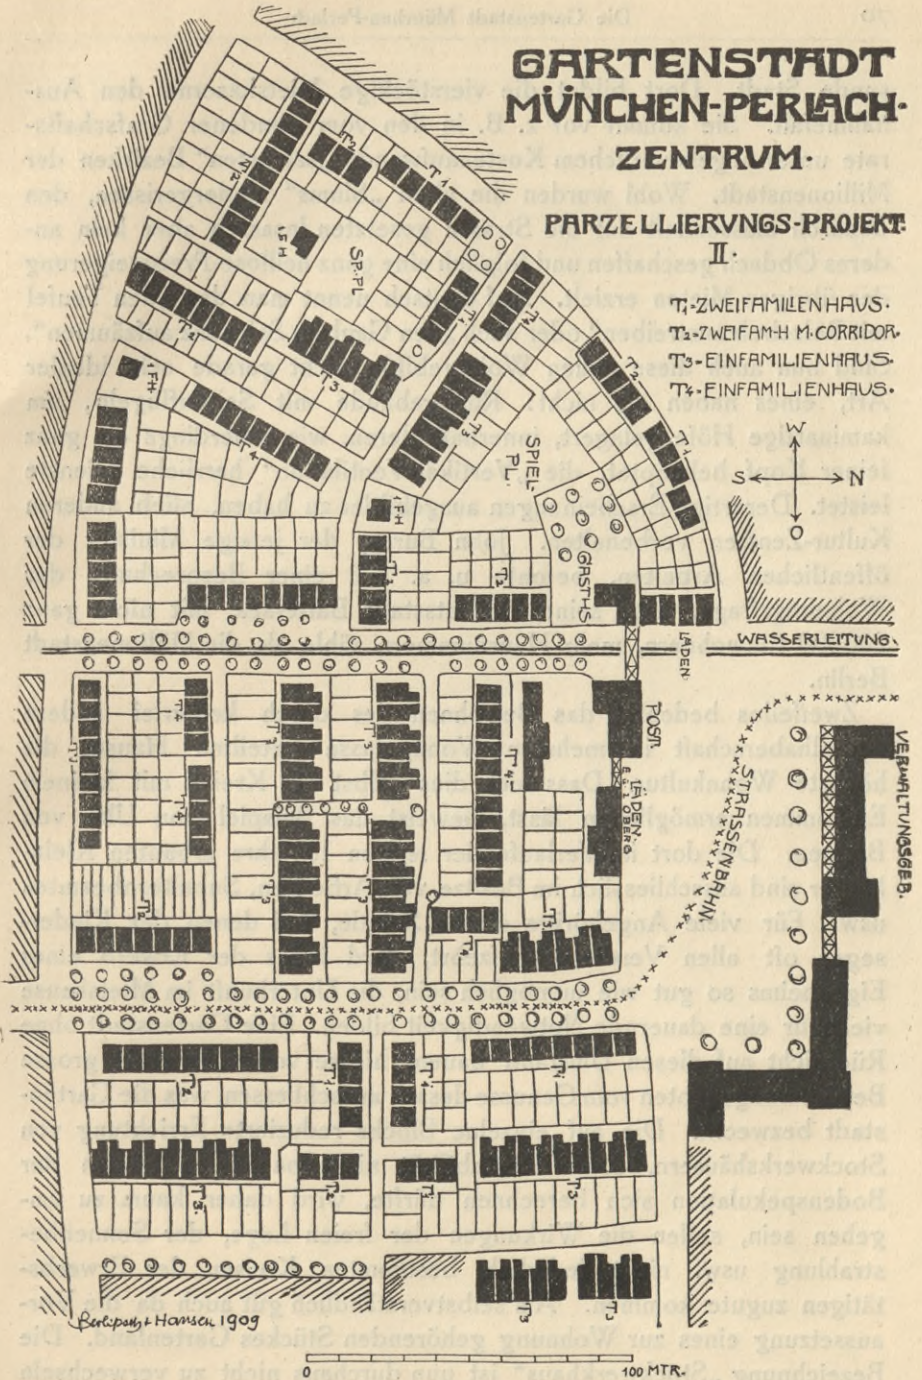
Gartenstadt Zentrum. Bearbeitete Teilfläche ca 8 ha. Bebauung vorzugsweise mit Reihenhäusern in drei Typen.
